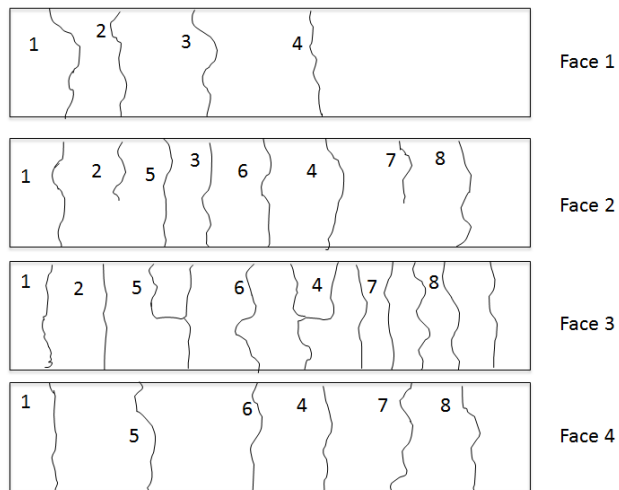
Fissuras típicas apresentadas nos tirantes.
